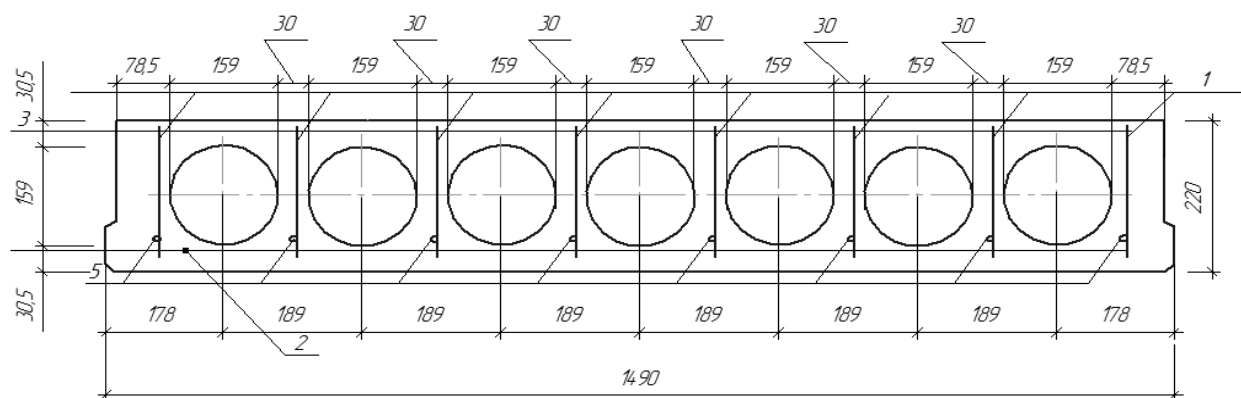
Поперечний переріз багатопустотної плити перекриття
